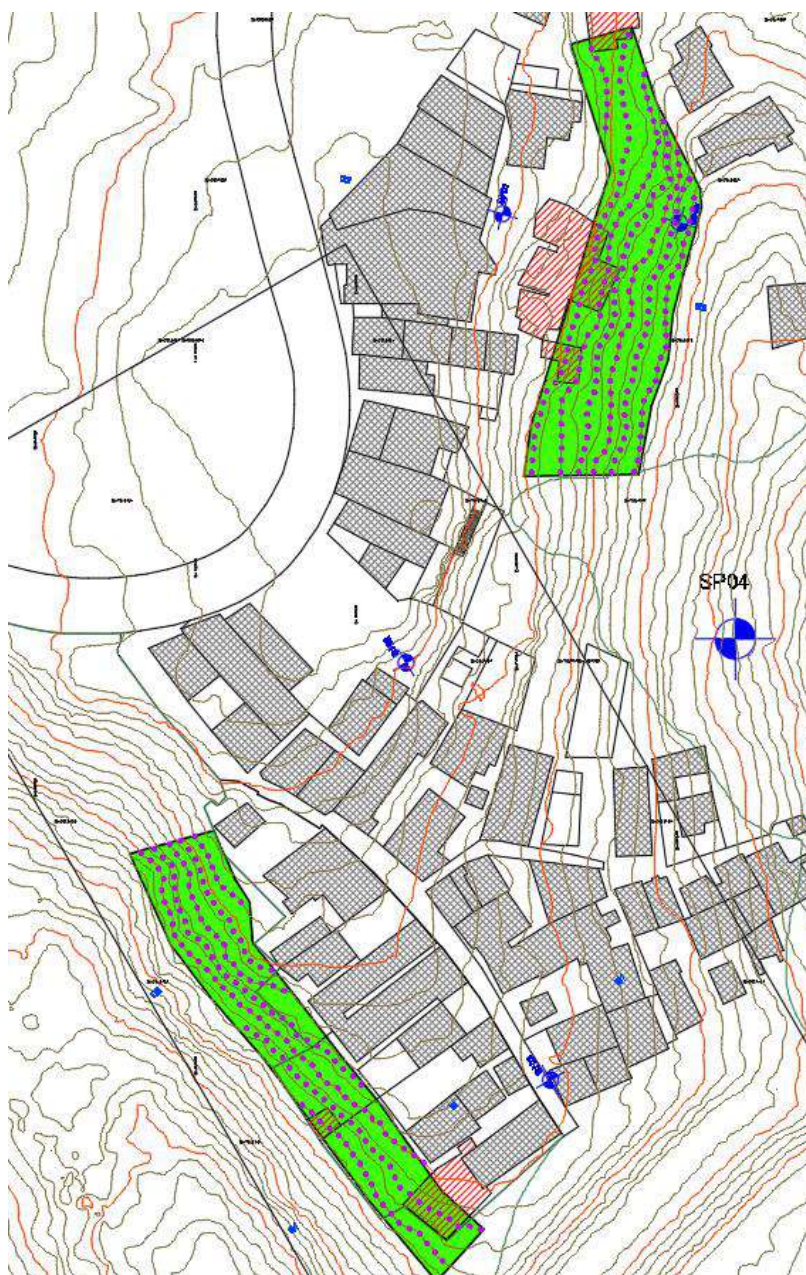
Imagem em Planta da solução adotada – Região da Rua Água nova, com grampos de 6,0 m.
